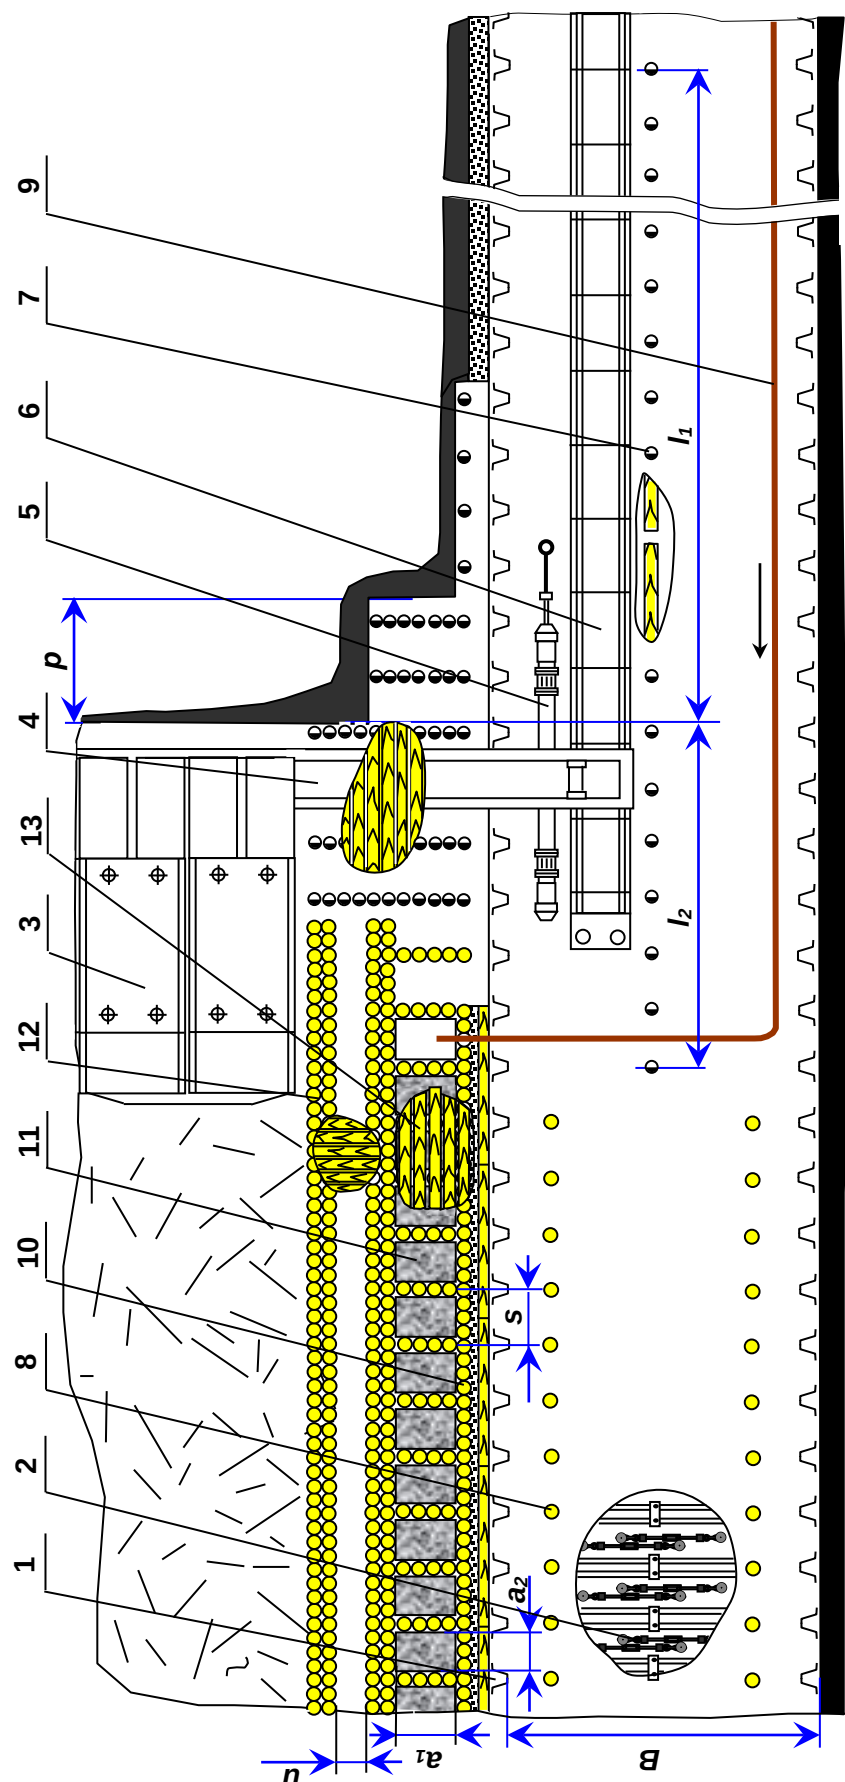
Заключний етап формування комбінованої охоронної системи по другому варіанту [2]: 1 – рамне кріплення, 2 – анкерне стяжне кріплення, 3 – щитове лавне кріплення, 4 – лавний конвеєр, 5 – домкрат пересування лавного конвеєра, 6 – штрековий конвеєр, 7 – гідростійки, 8 – дерев’яні стояки підсилюючого кріплення, 9 – трубопровід для подачі розчину, 10 – однорядне органне кріплення, 11 – жорстка літа смуга, 12 – дворядне органне кріплення, 13 – дерев’яна затяжка покрівлі
